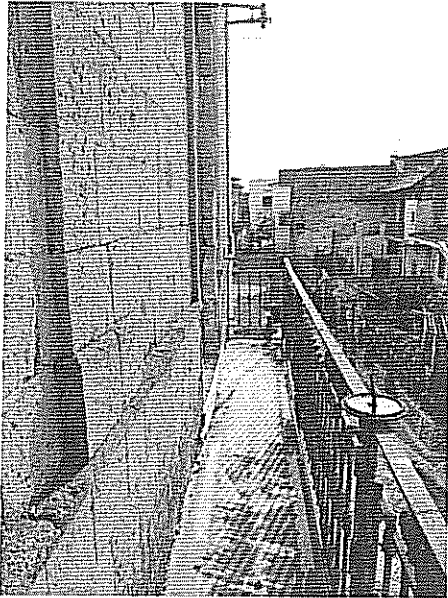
la ripresa mostra il balcone esterno del lotto n.1, prospettante su Via Molino.
